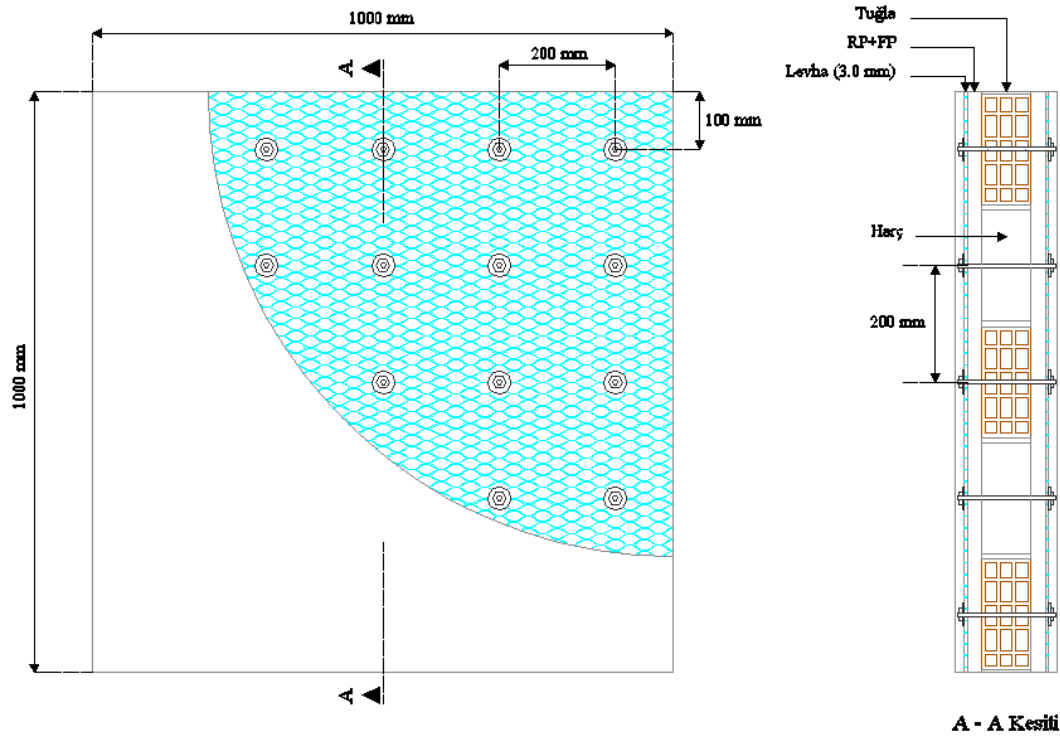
FP2,0-200 deney elemanın boyutları ve güçlendirme detayları
